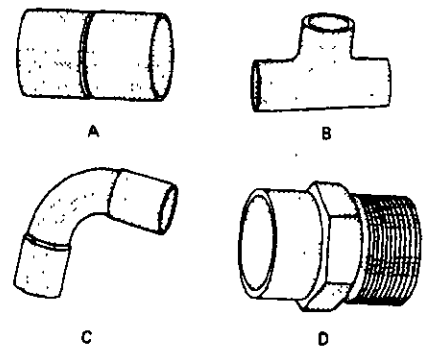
Algunas conexiones comunes de soldar o latonar con tubo de cobre a) cople con tope para soldar; b) te para soldar; c) codo de 90° para soldar; d) adaptador rosca macho de tubo para soldar. (Cortesía de Mueller Brass Company)
